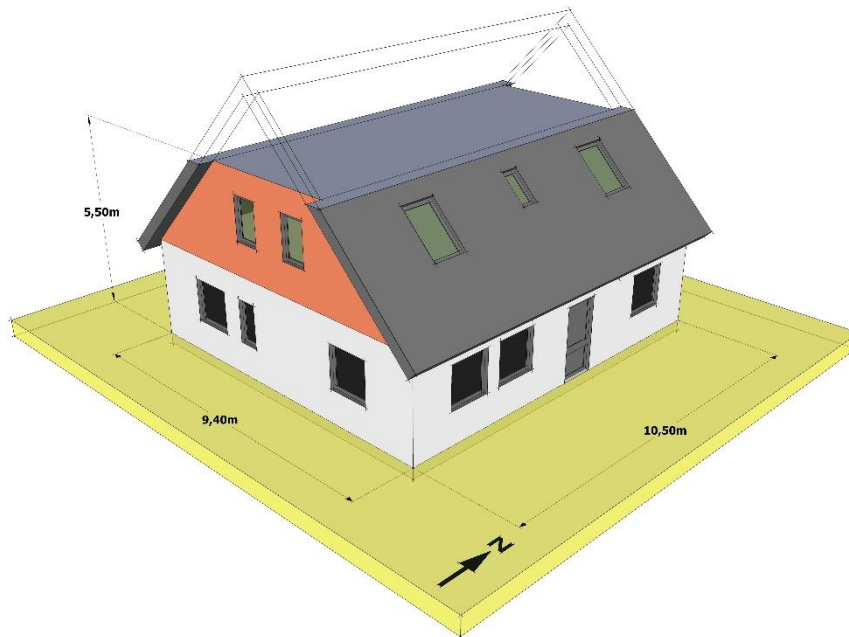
Schematische Darstellung der betrachteten Hüllflächen des Dachgeschossausbaus.
